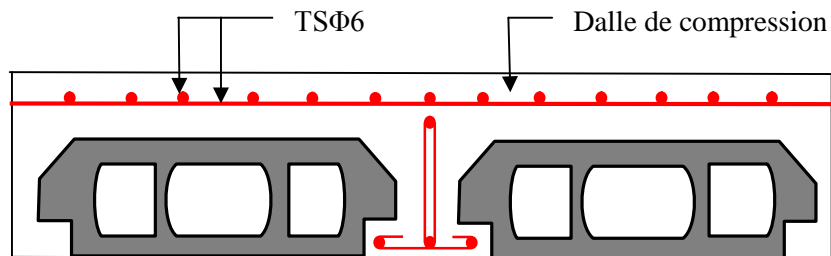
Schéma de ferrailage de la dalle de compression.
